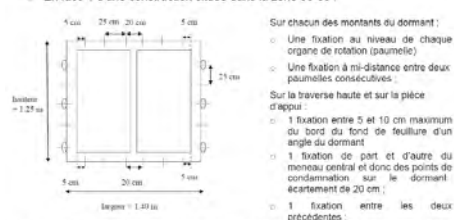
Exemple de disposition des fixations pour une fenêtre à ouverture à la française de dimensions largeur = 1,40 m, hauteur = 1,25 m en face 1 d'une construction dans la zone 35-50
